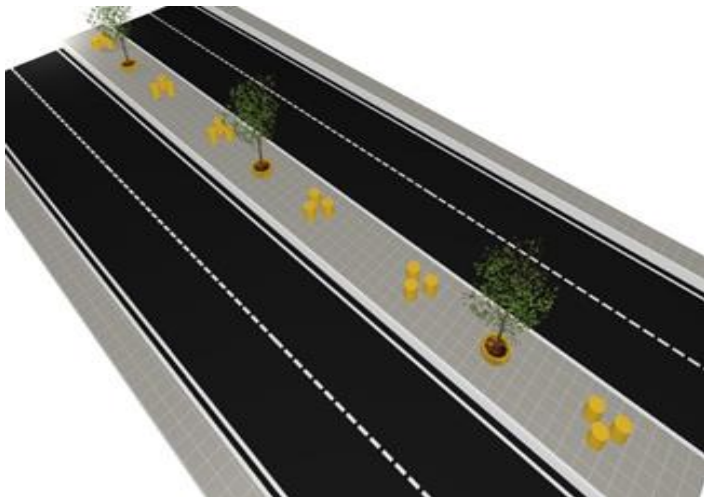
Canteiro central da Avenida Getúlio Vargas com as placas pré-moldadas de concreto com PET, vista em 3D.
